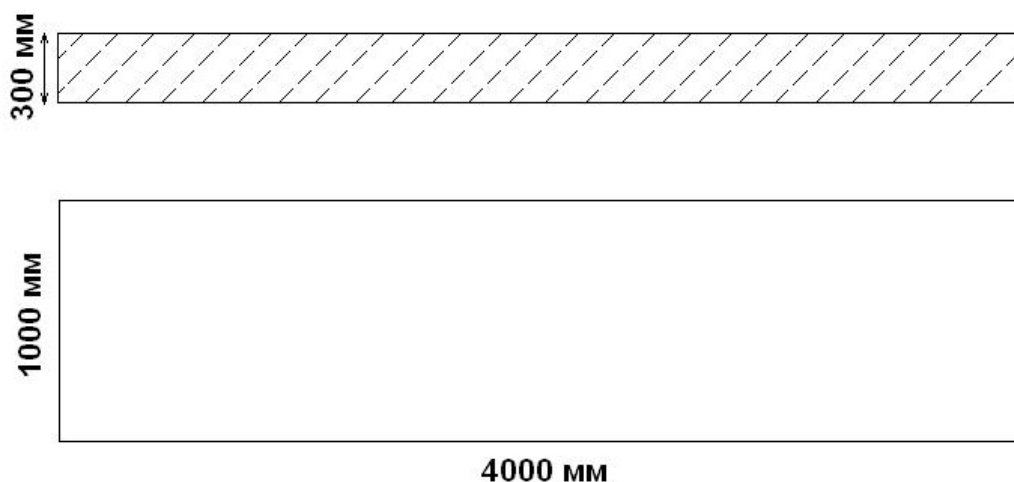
Размеры бетонного основания для подъемника П-4Г
